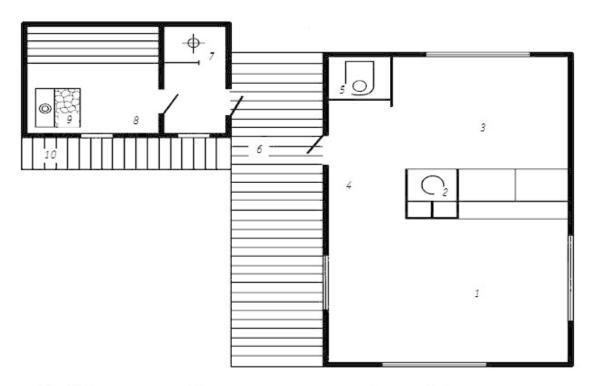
План размещения бани рядом с домом с открытой верандой: 1 — жилая комната; 2 — кухонная печь; 3 — кухня; 4 — передняя; 5 — туалет; 6 — веранда с навесом; 7 — душевая; 8 — парильня; 9 — печь-каменка; 10 — скамейка под навесом
